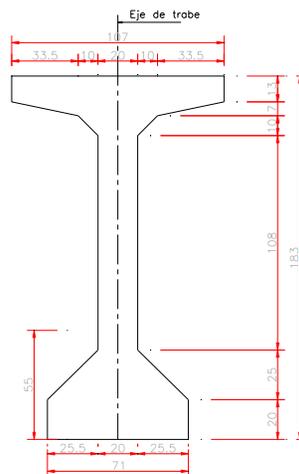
Trabe AASHTO VI. Puente “Las Lajas III”
